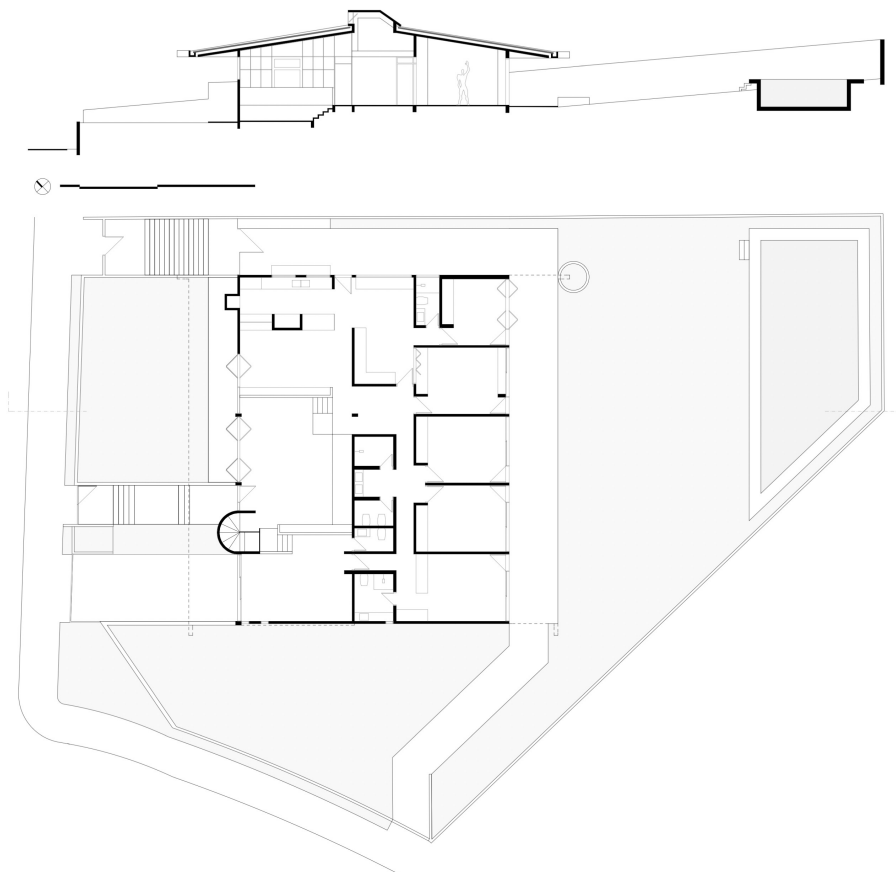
planta e corte longitudinal da Residência Clotilde e Sérgio Ferreira.
